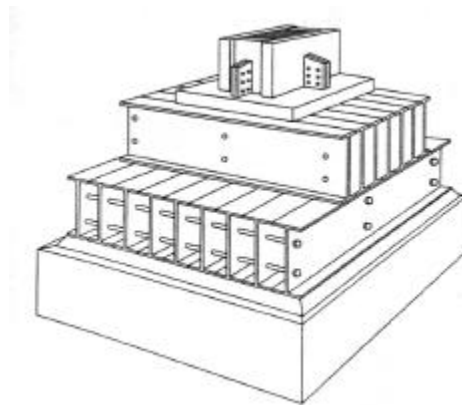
Anschlussdetail der Stahlkernstützen des Hochhauses „World Trade Center“ New York, an den Stahlbetonfundamentsockel. [Phocas 2001, S. 87]
